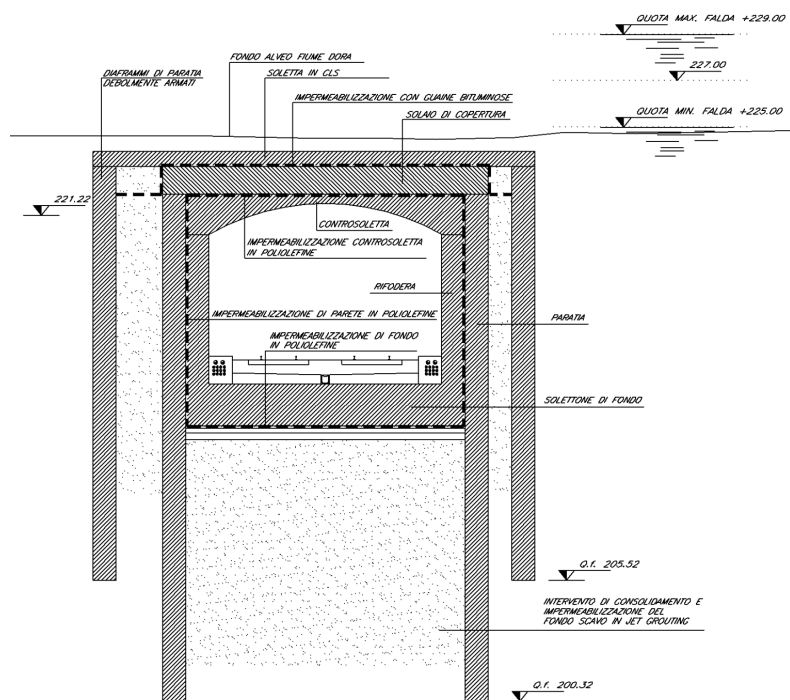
Sezione sottoattraversamento fiume Dora Riparia. Section through underpass under River Dora Riparia (Max stratum height +229.00; Bottom of river Dora riverbed; Bulkhead diaphragm; Slabbing in c.l.s.; Slightly reinforced; Waterproofing with bituminous coating; Floor of covering; Min. stratum height +225.00; Counter-Slabbing; Waterproofing of counter-slabbing in polyolefin; Liner; Waterproofing of bulkhead in polyolefin; Bulkhead; Waterproofing of bottom in polyolefin; Slabbing on bottom; Consolidation work on bottom; Excavations with jet grouting).
